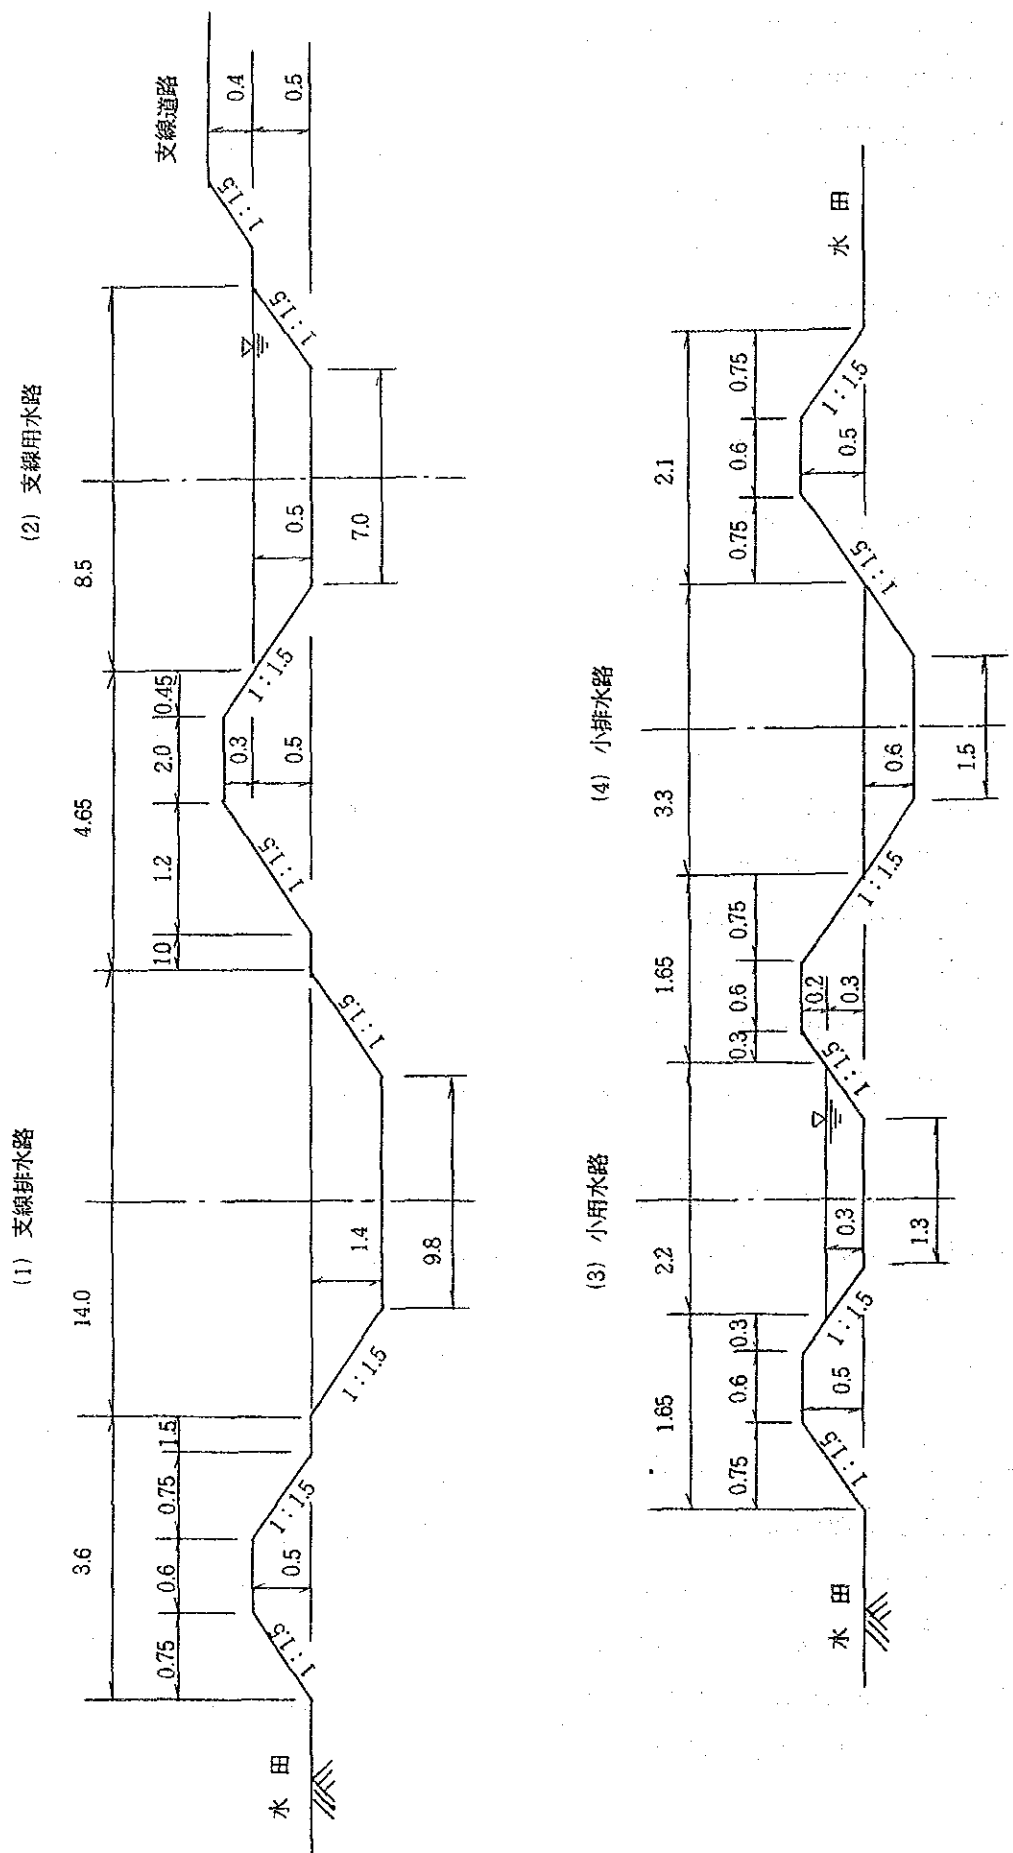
水田開発モデル 用排水路標準断面図 (単位: m)
